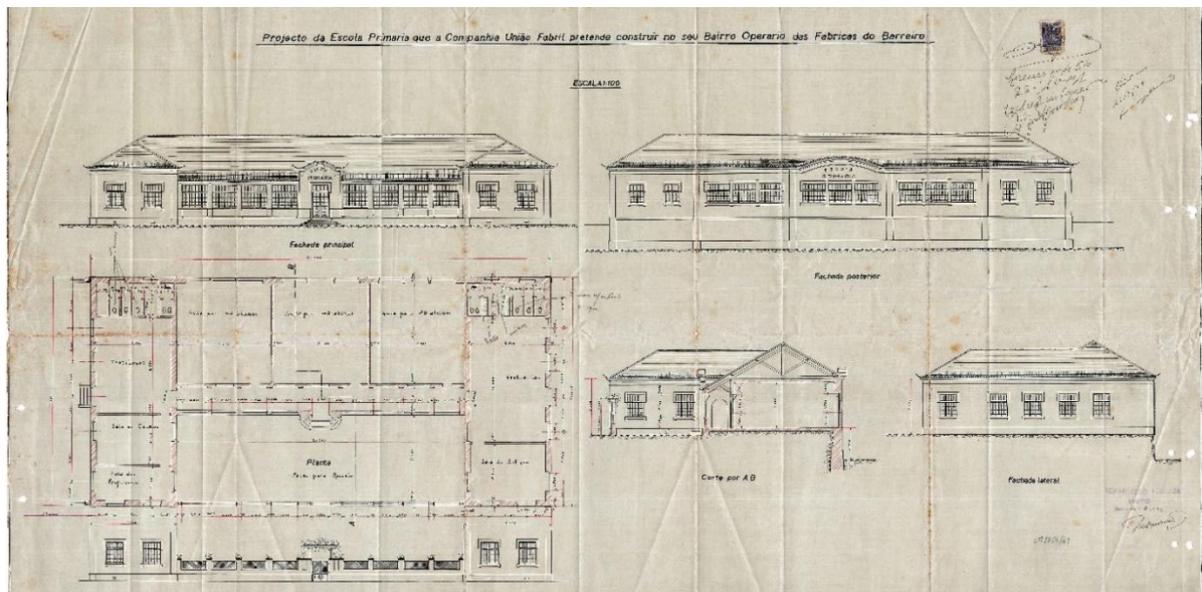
Fachada principal, Planta, Fachada posterior, Corte por AB e Fachada lateral do projeto da Escola Primaria
